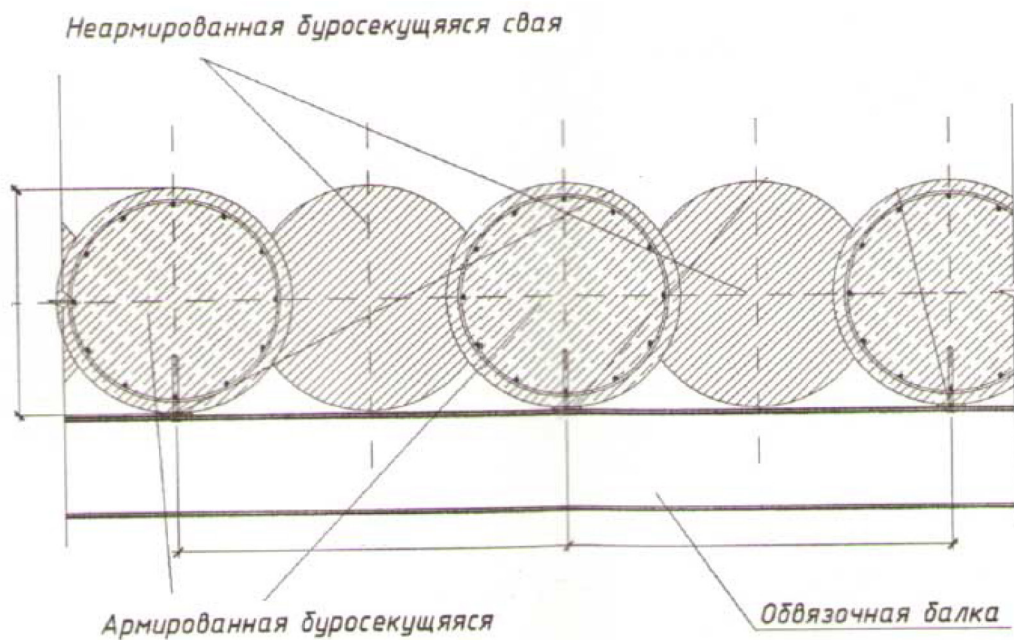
Последовательность формирования ограждающей конструкции котлована из буросекущих свай
